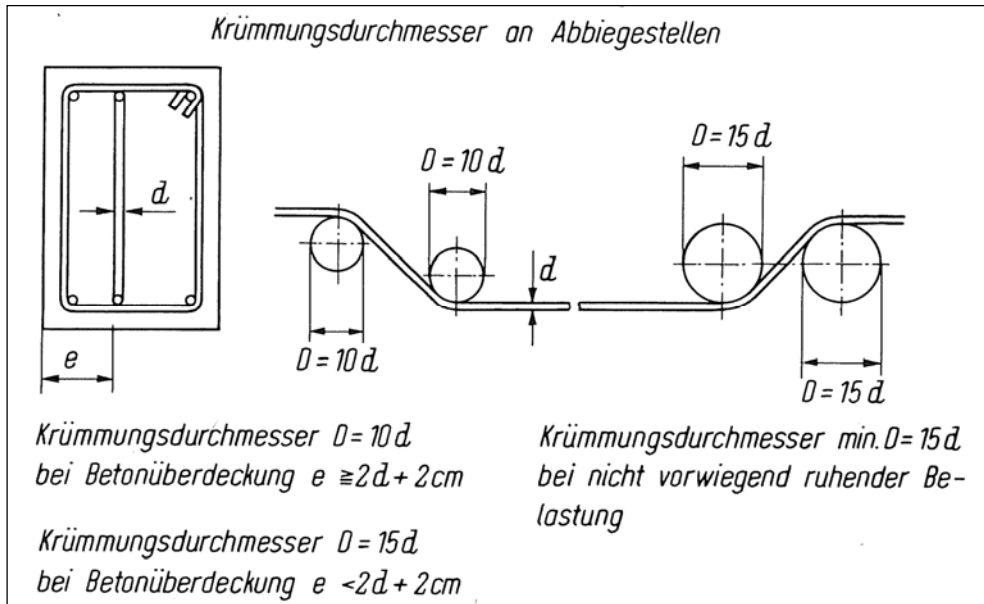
Biegerollendurchmesser für Betonrippenstahl I und IIIa, b nach Zulassung.
